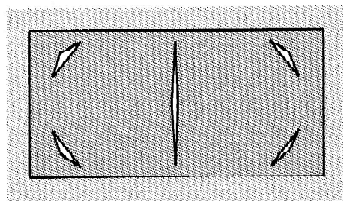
四周拘束の場合のひび割れ発生予想図³⁾
